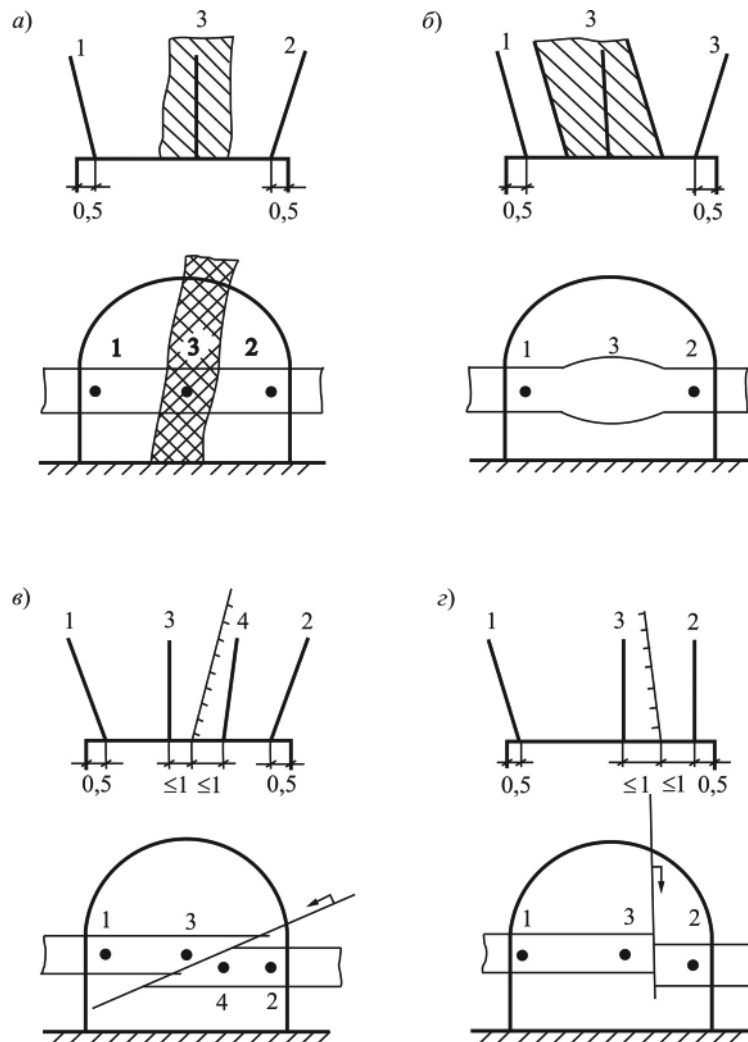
Схемы расположения шпуров в зонах нарушений на угрожаемых и выбросоопасных угольных пластах (вид спереди и разрез): а) – структурное нарушение; б) – пликативное нарушение; в) и г) – разрывные (или дизъюнктивные) геологические нарушения
